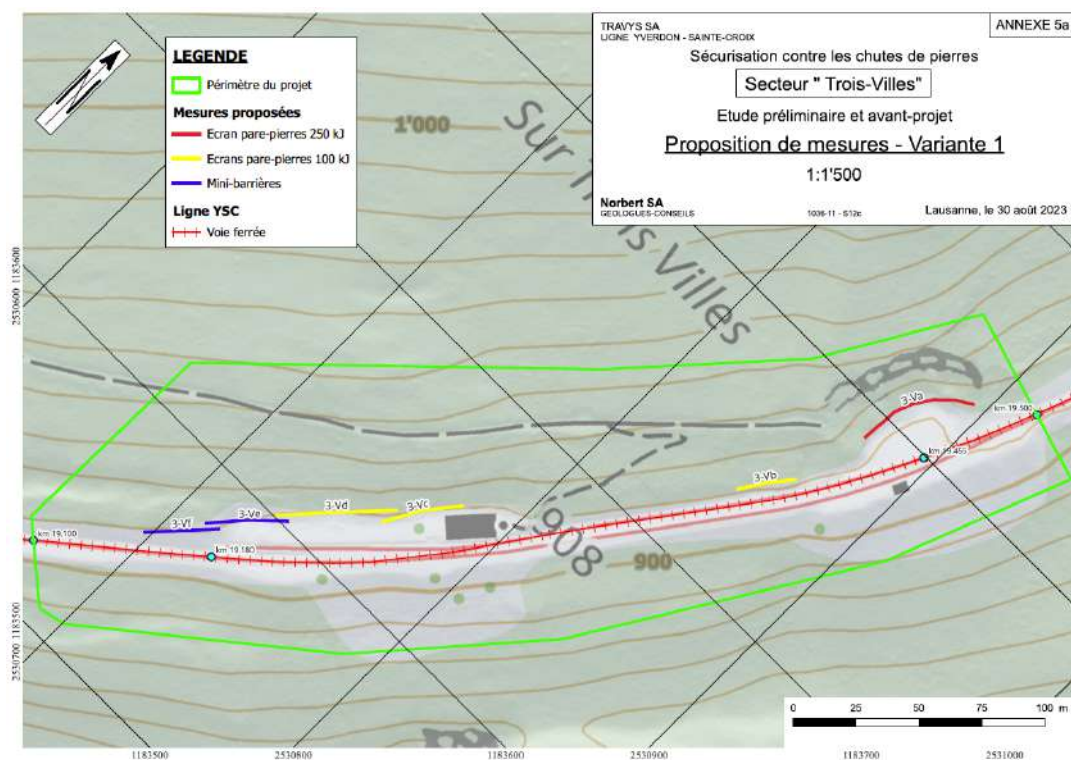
Proposition de mesures pour le secteur Trois-Villes - Variante 1. Source : Rapport géologique Norbert SA
